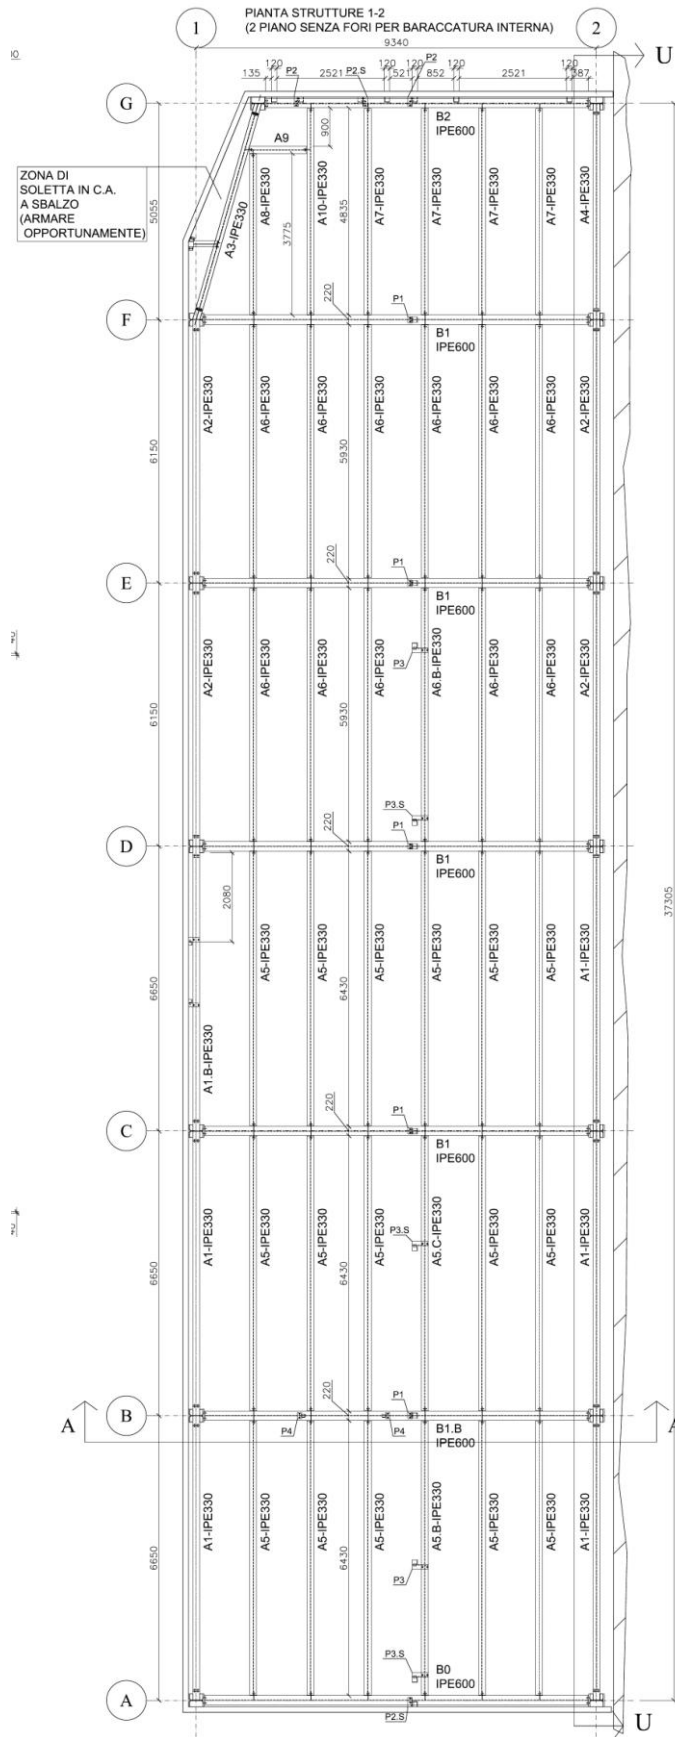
Particolare di A.2006.a.us.T03 - Piante - Pianta piani primo e secondo
